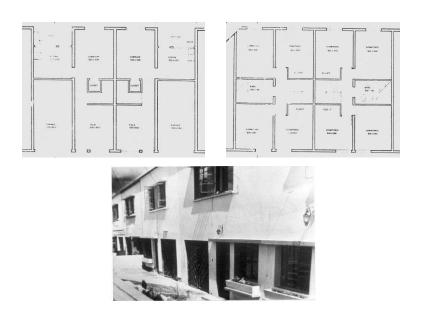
Casa Económica, Urbanización Los Rosales, 1947. Planta baja (izq.) y alta (der.); Vista. c. 1948 (centro). (Planos tomados de: INAVI, Planoteca, 1947-a; fotografía tomada de: López, 1985).
